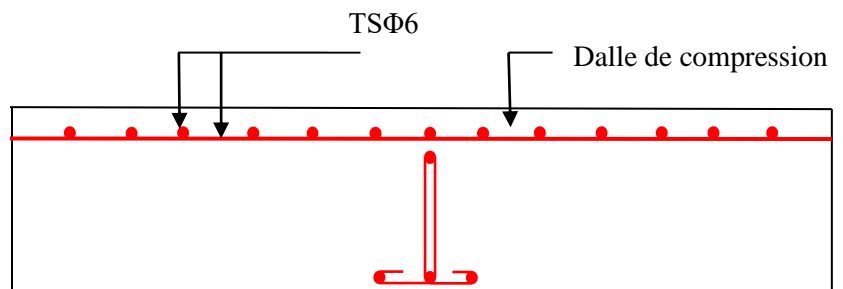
Schéma de ferrailage de la dalle de compression
